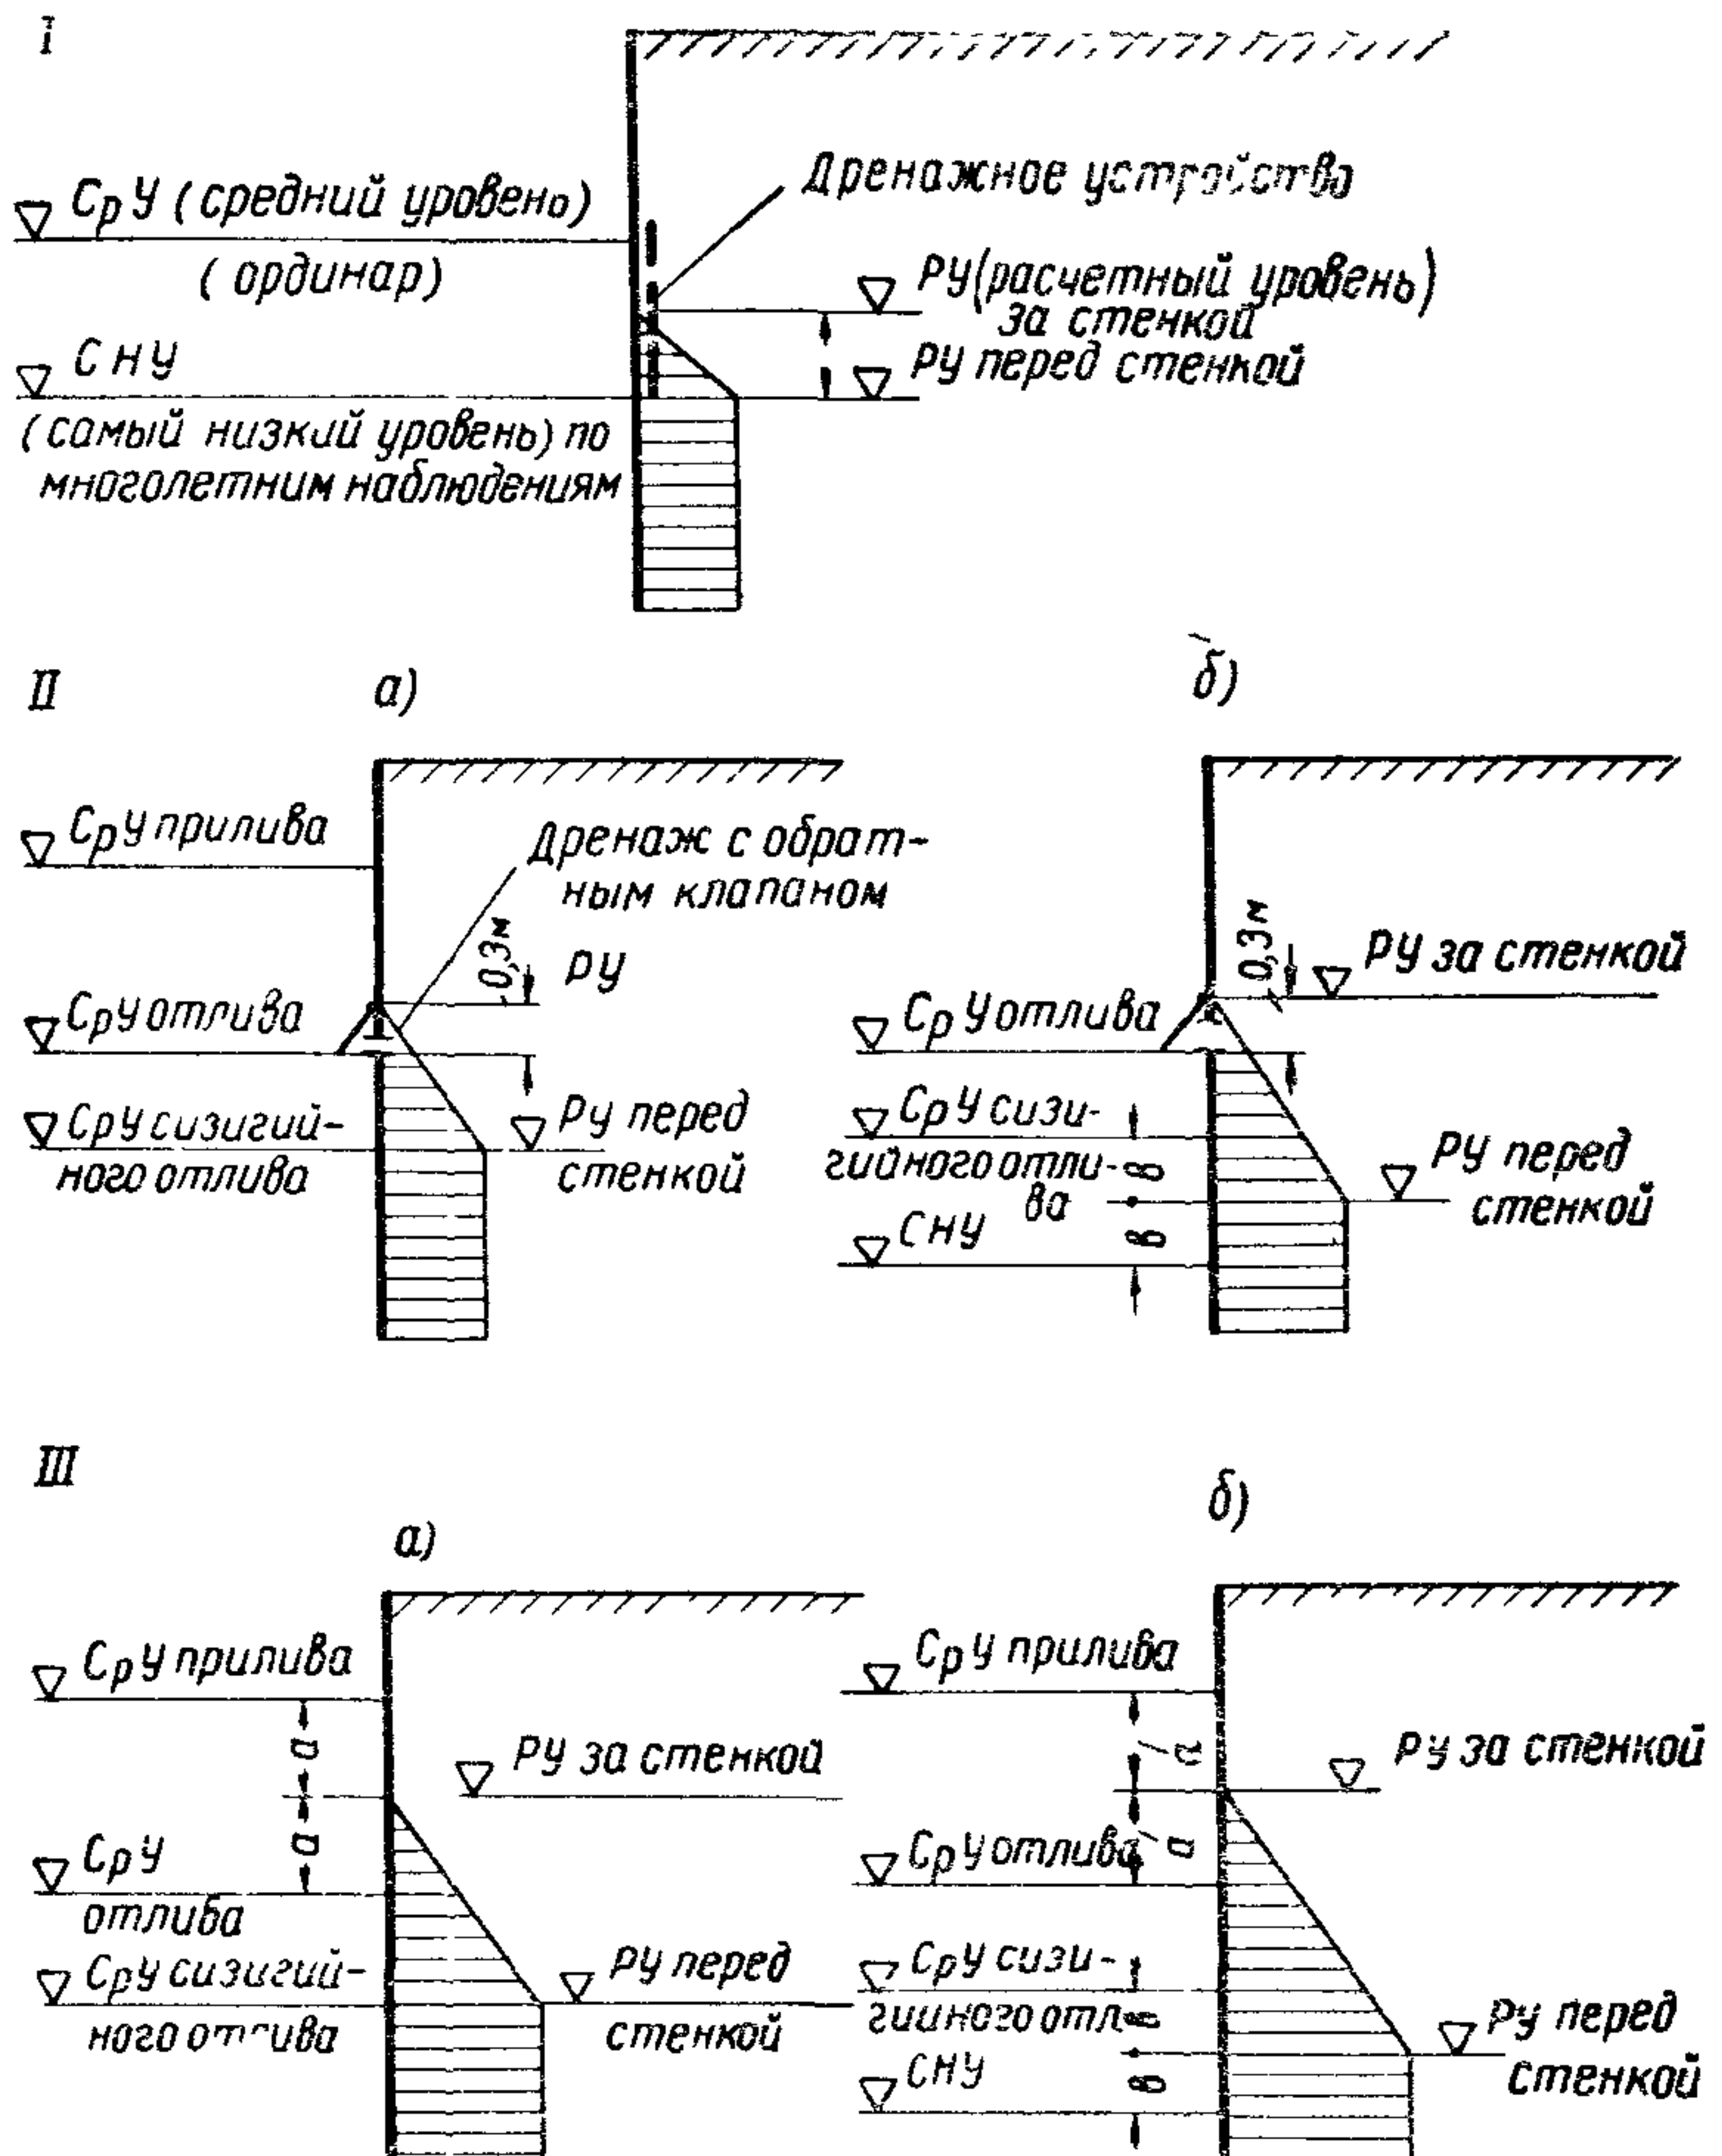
Расчетные давления воды на стенки свайных двухрядных конструкций
